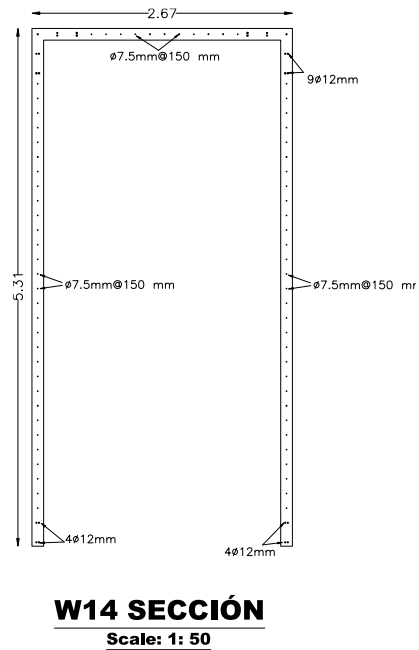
Geometría y refuerzo típico del Muro W14.
